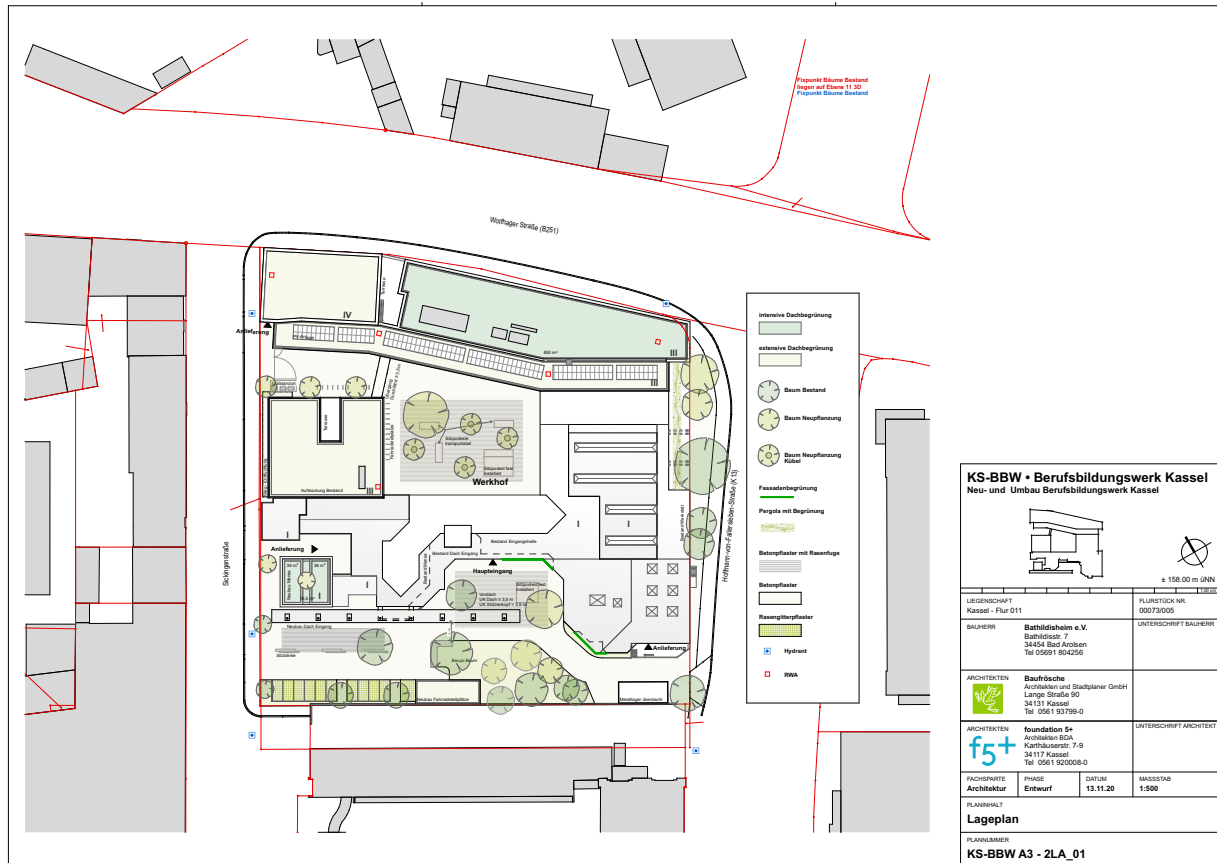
Dachaufsicht Bestand und Neubau, Quelle: foundation 5+ Architekten & Baufrösche
